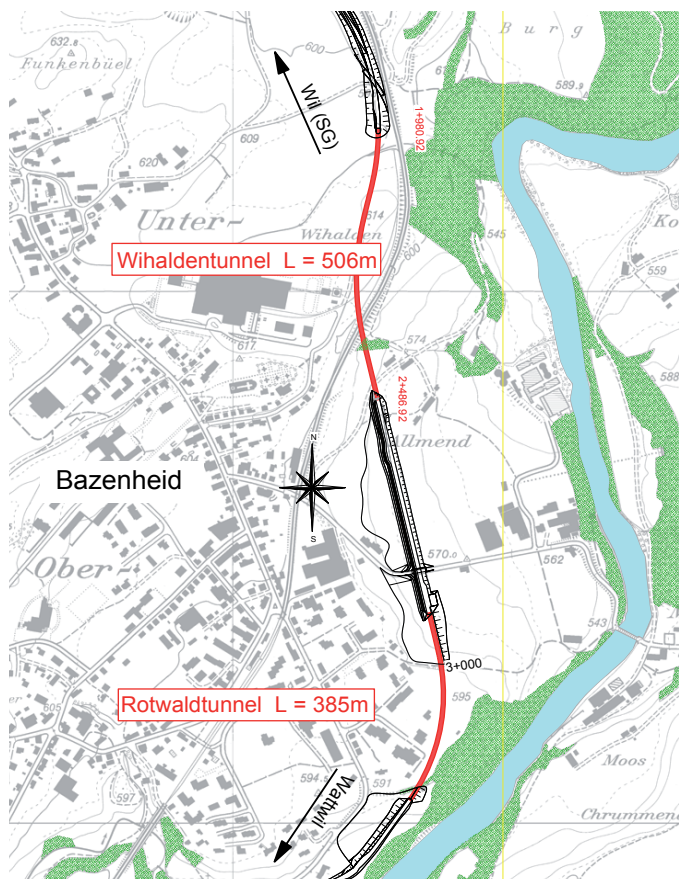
Umfahrung Bazenheid, Übersicht mit Wihalden- und Rotwaldtunnel
